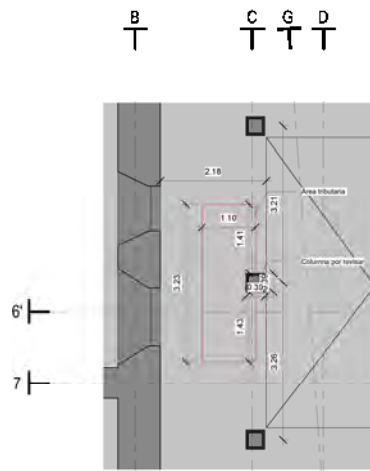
Área tributaria de sistema constructivo de pilares en el primer patio. CAMEM. Elaboró: METR
